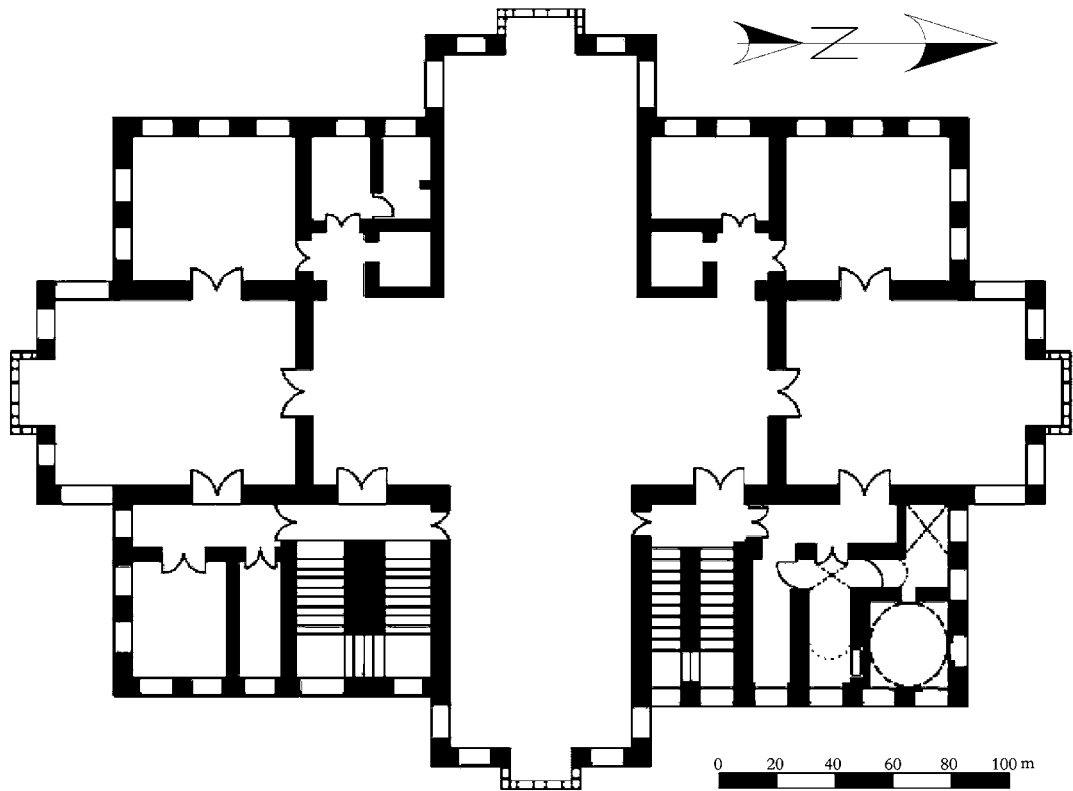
بيت الكعكي: مسقط أفقي للطابق الأول ويلاحظ توزيع ومواقع وحدات الحمامين. (عمل بمعرفة الباحث).
